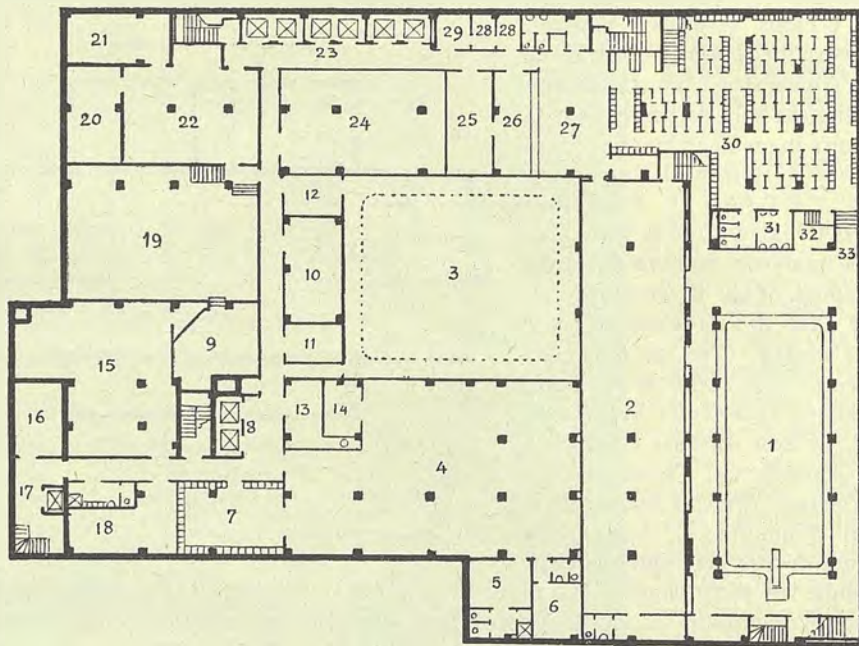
a, b. — Edificio della *American Women's Association* di New-York (arch. B. Vistar Morris).
